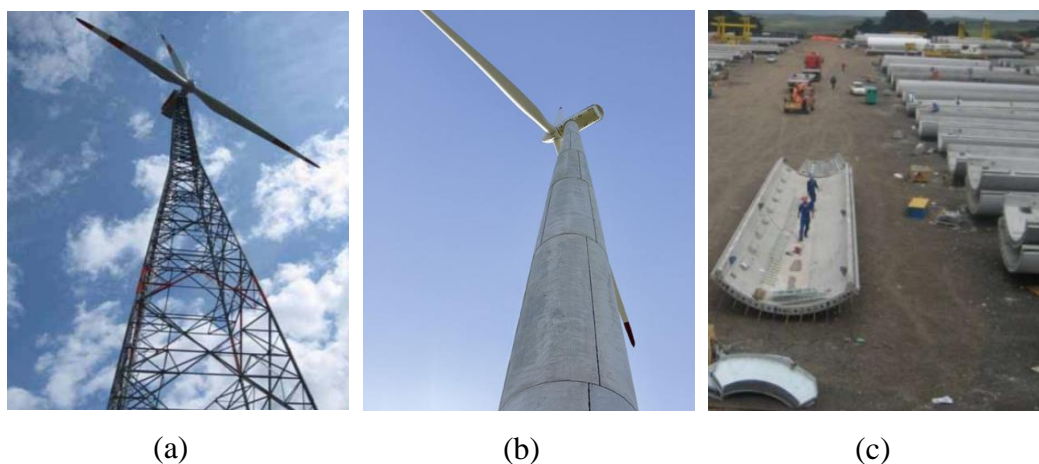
Torre eólica: (a) treliçada, (b) concreto protendido, (c) módulo do pré-moldado de concreto protendido.
